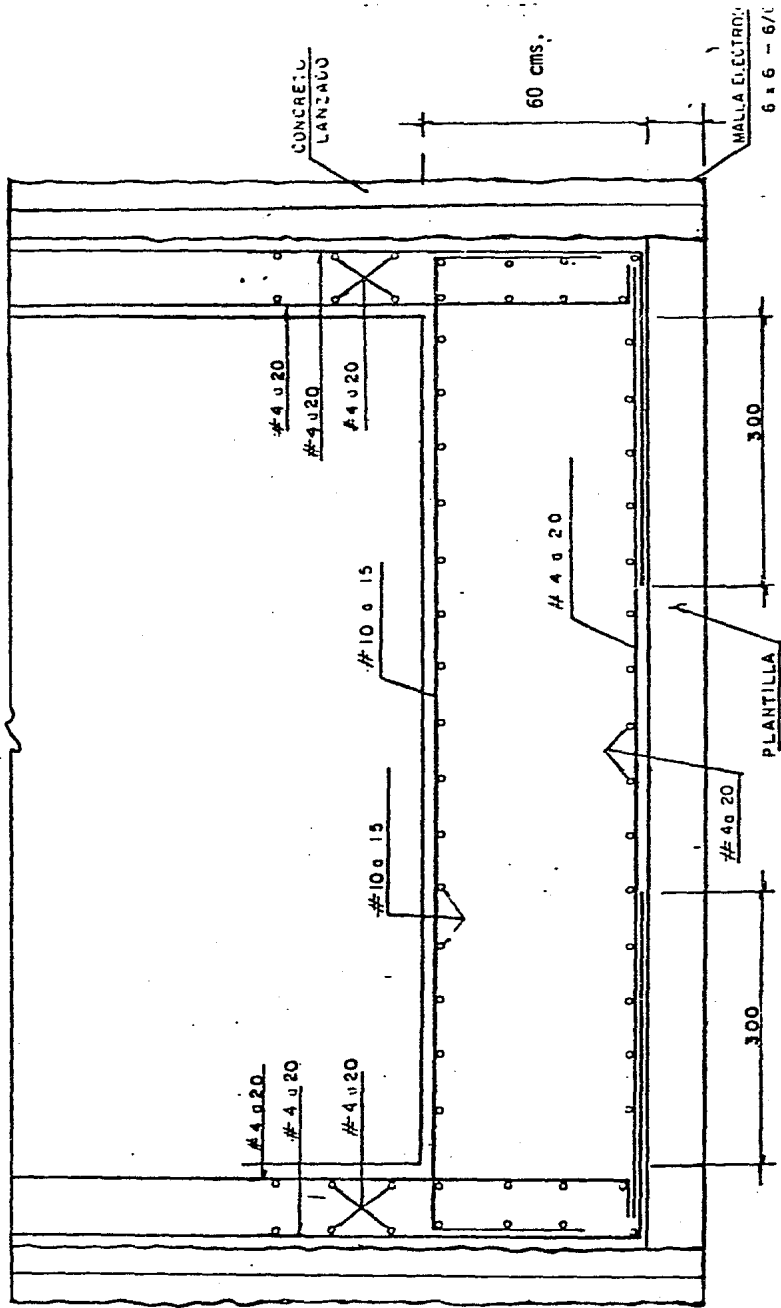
Armado de la losa de fondo y muro de Tumbreira
